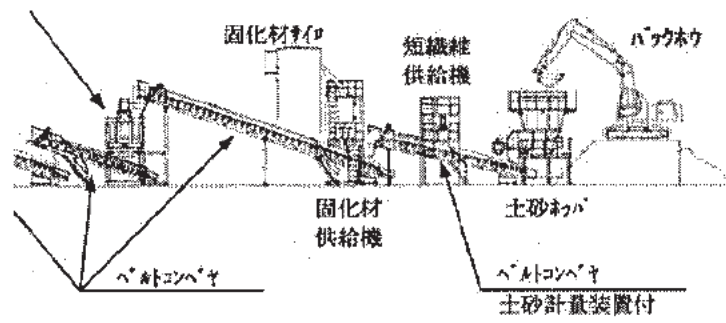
回転式破碎混合方式（工法3）の施工手順図
